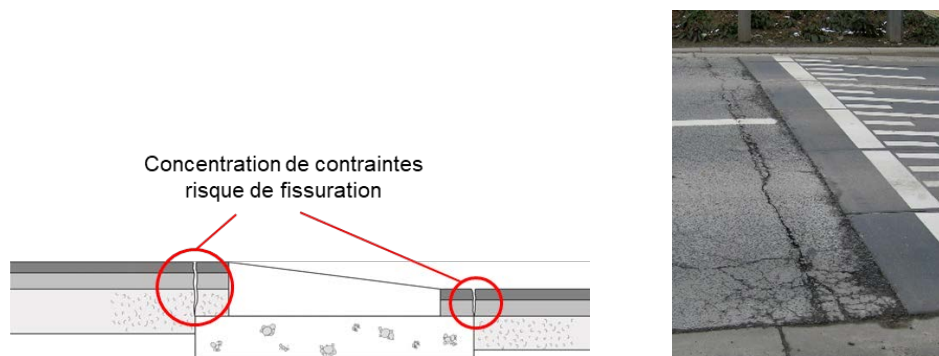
Remontées de fissures au joint entre fondations différentes
